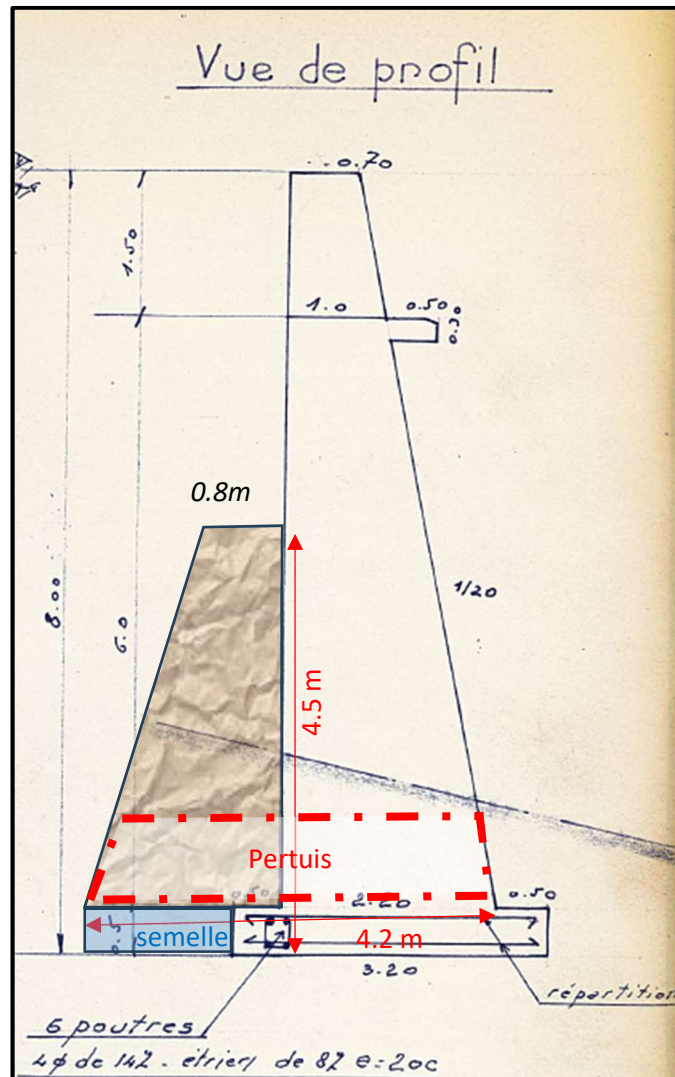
Coupe de l'ouvrage aval et figuration du renfort en enrochement
